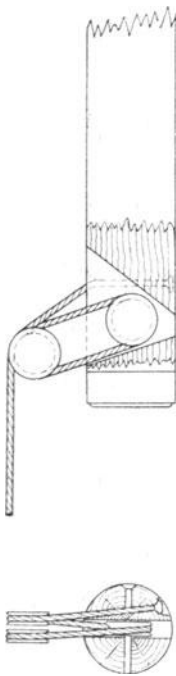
Führung der Drähte für das Niederlegen des Mastes.
